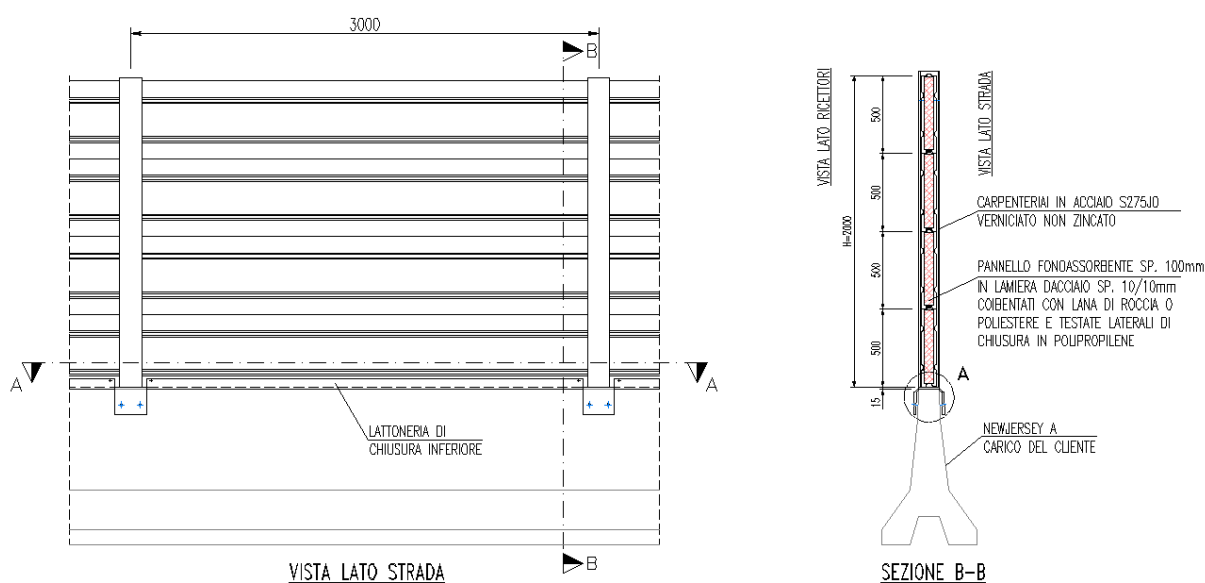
Tipologico barriera fonoassorbente da cantiere
